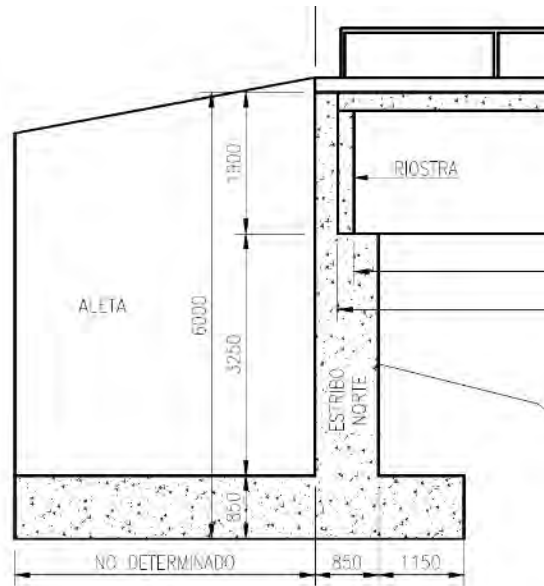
Dimensiones del tipo de cimentación del plano de levantamiento realizado al paciente por el equipo de trabajo del presente estudio
